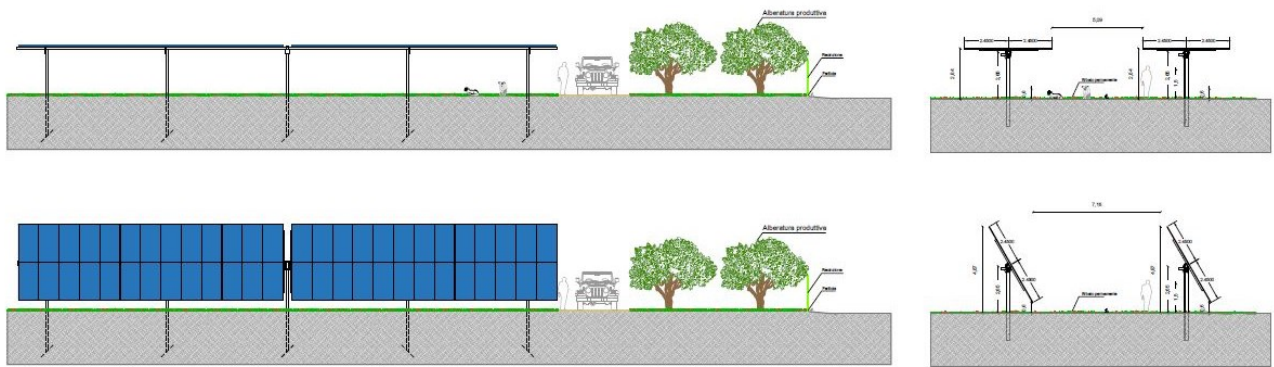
Sezione significativa del sistema di mitigazione perimetrale
